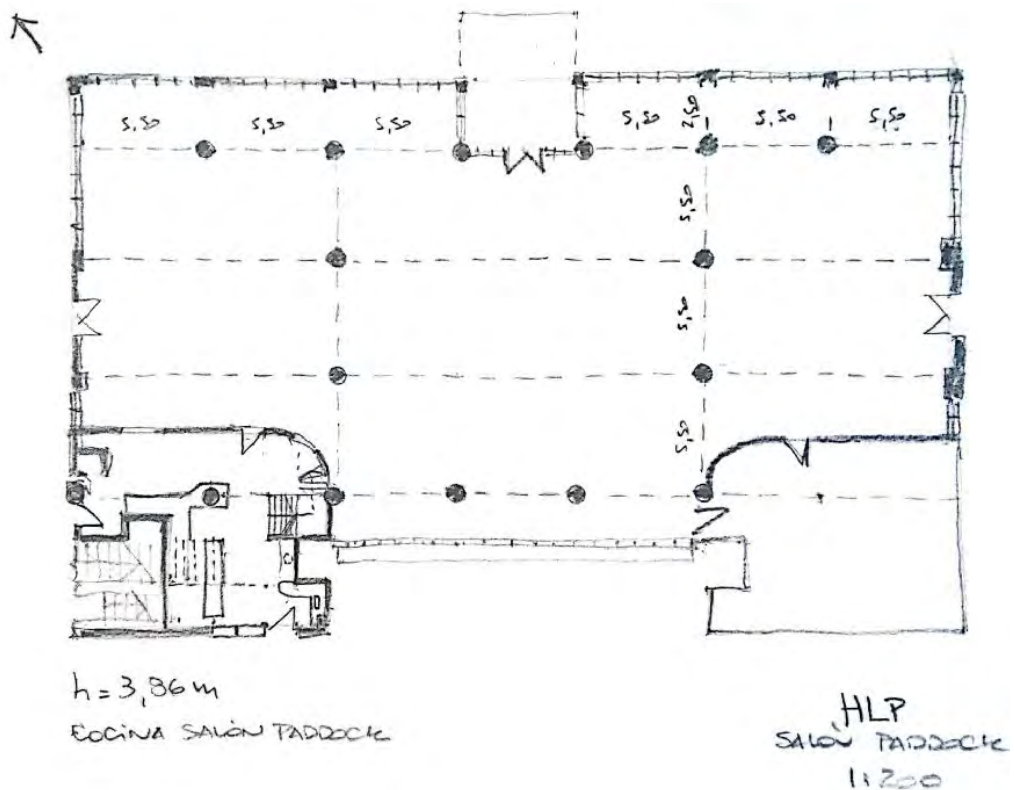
Plano Tribuna Popular Vieja. Planta Baja. Confeccionado a partir del relevamiento realizado
